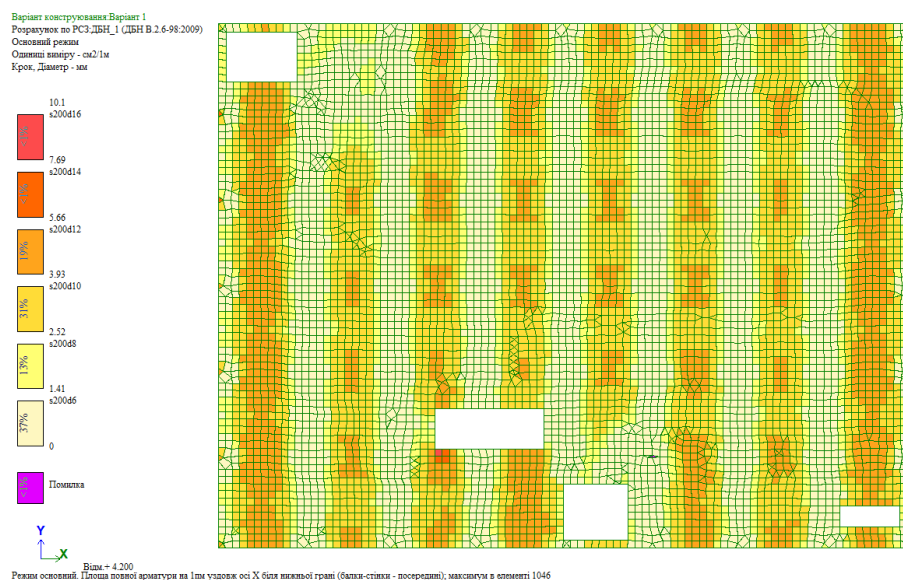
Мозаїка армування плити перекриття в напрямку X
